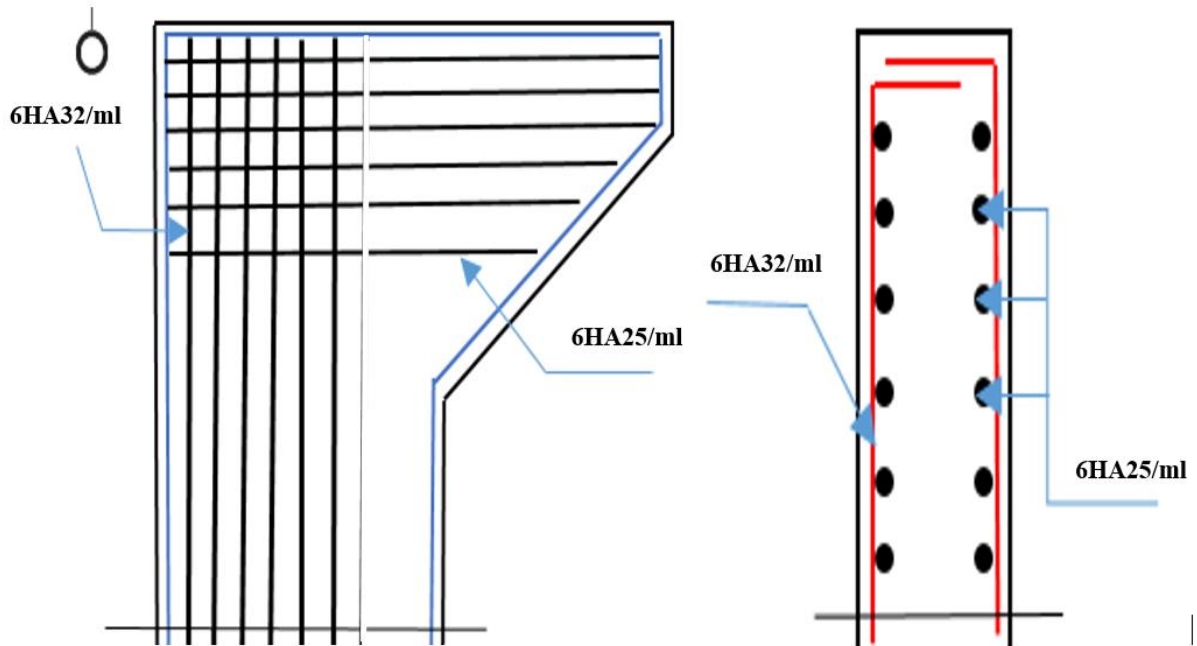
FERRAILAGE DU MUR EN RETOUR
